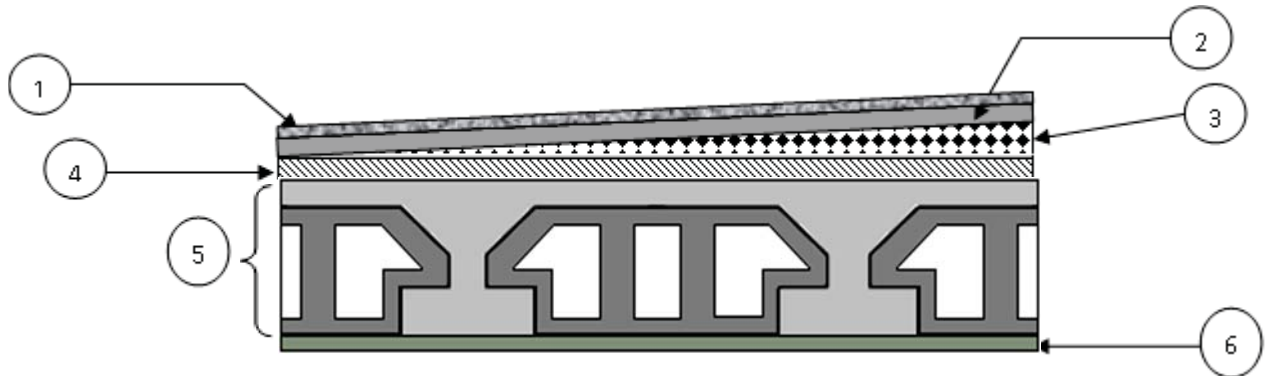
Coupe transversale d'un plancher terrasse inaccessible
